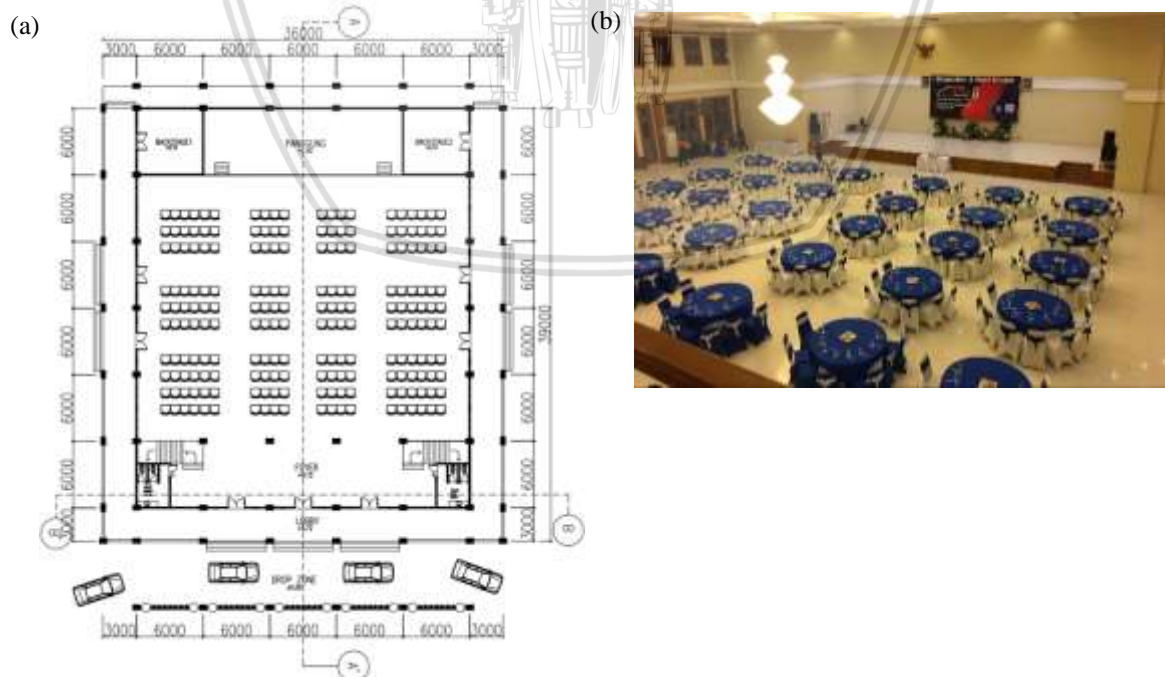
(a) Denah *Ballroom upper floor* Aisawan Resort & Spa (b) *Ballroom* Aisawan Resort & Spa
